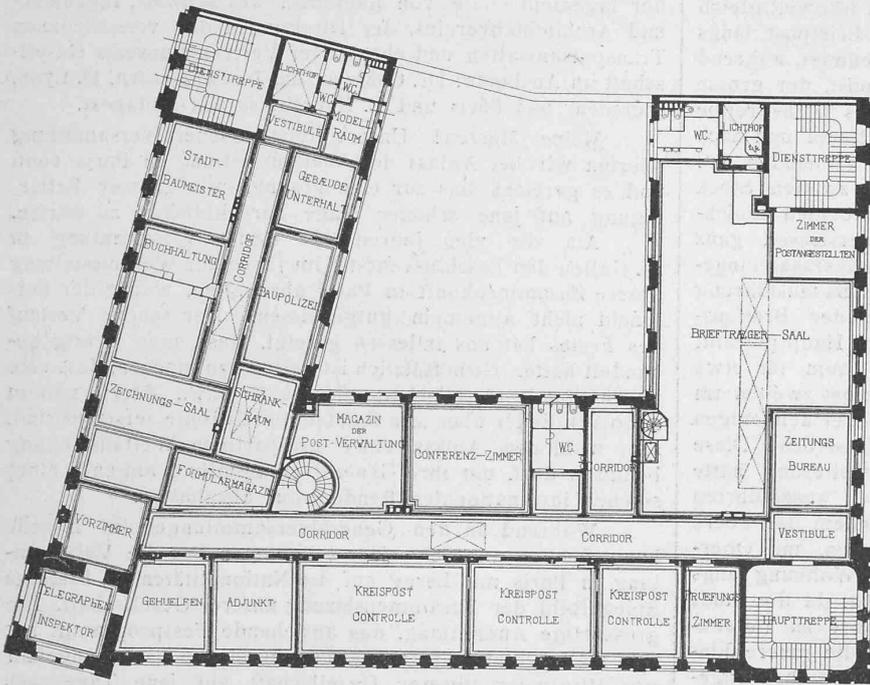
Grundriss vom II. Stock. — Masstab 1 : 500.
